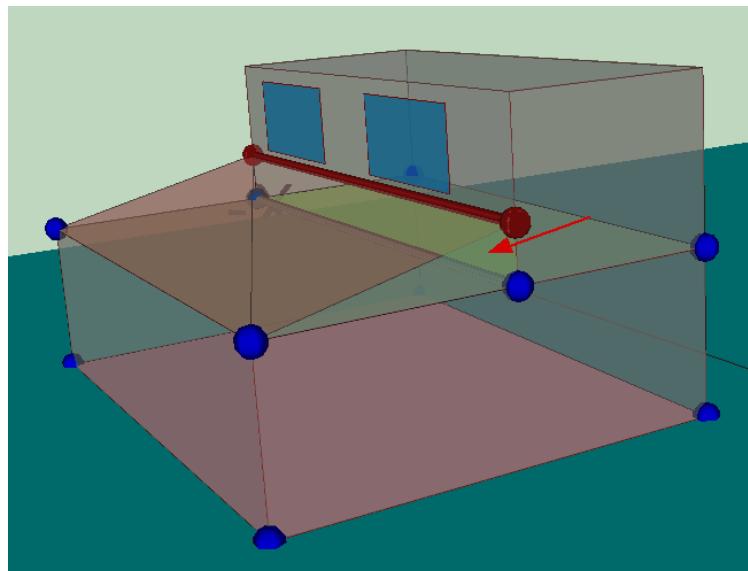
Tabique rectangular de espacio bajo cubierta inclinada
